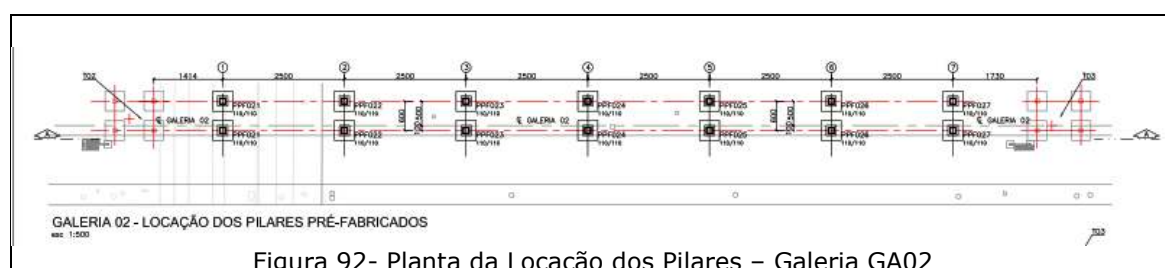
Planta da Locação dos Pilares – Galeria GA02
